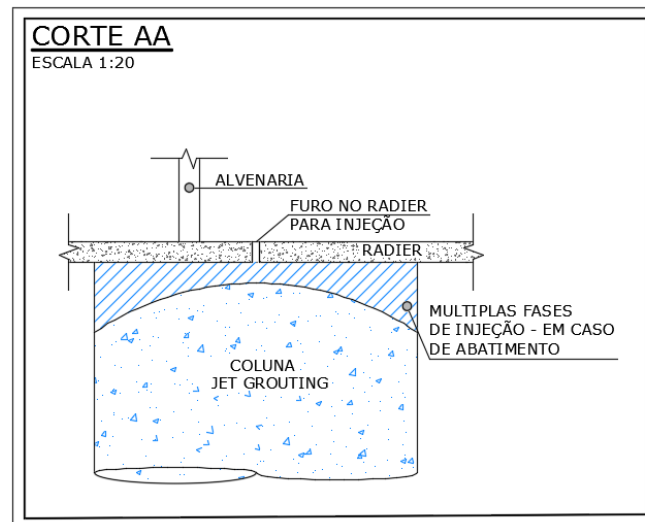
Detalhe da furação da laje (Fonte: Projetista, 2017).
